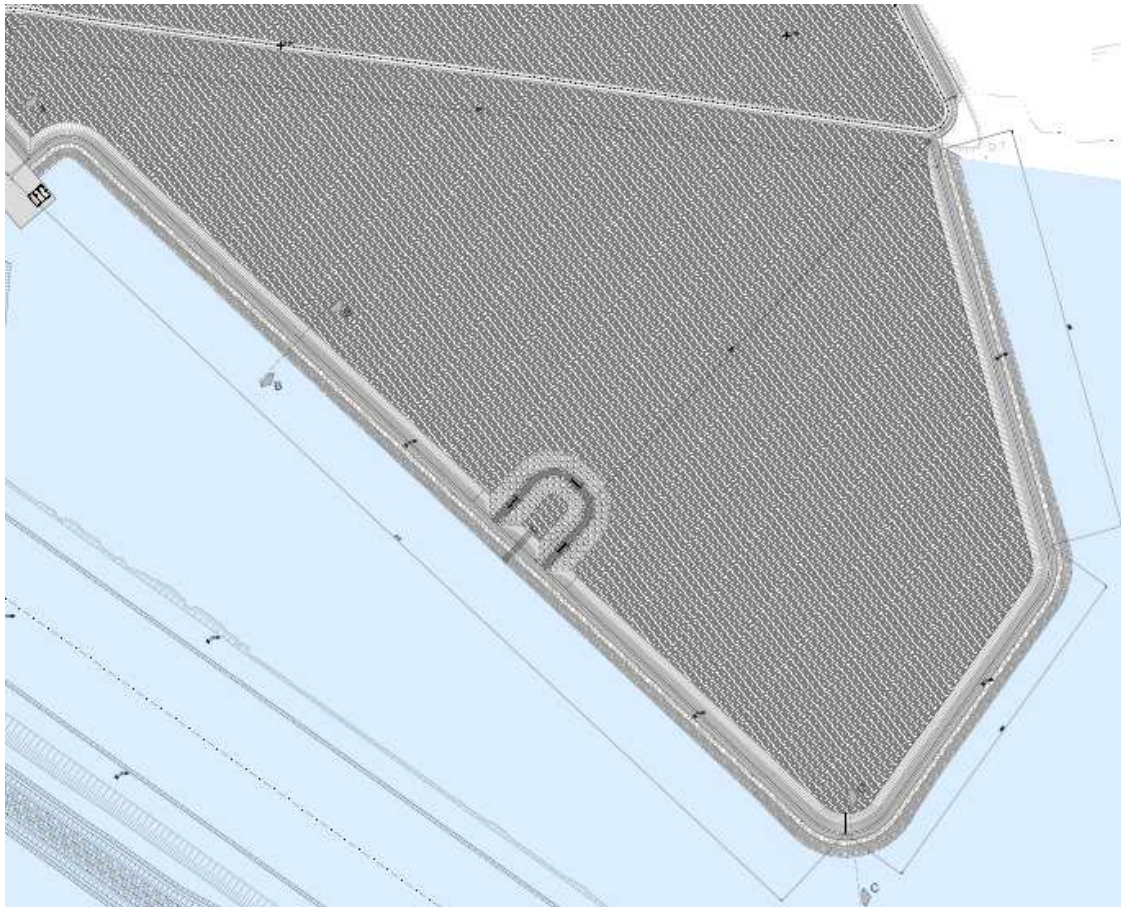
Area 8 - Planimetria Cassa di Colmata
